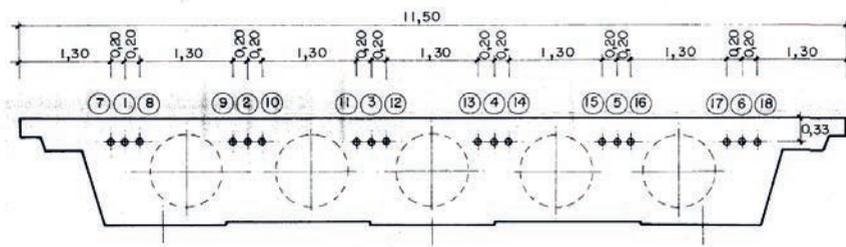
Sección transversal de la losa pretensada (apoyos pilas)
